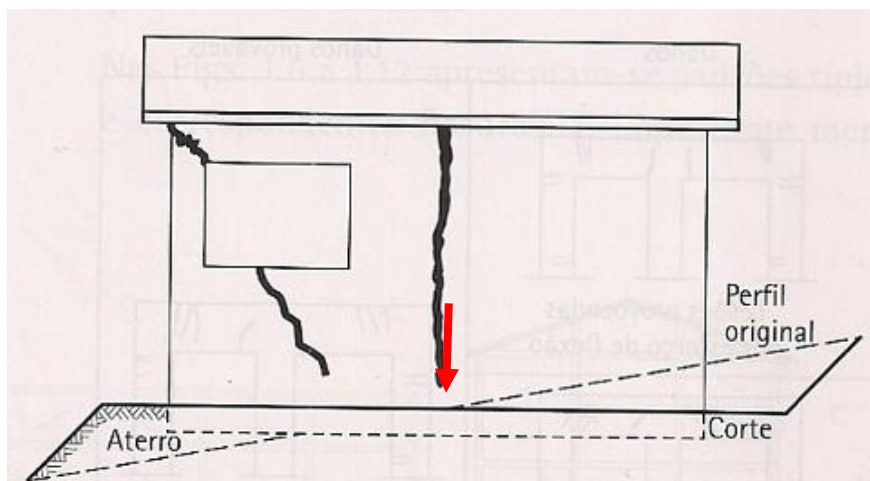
Provável fissuramento de edificação assente parte em aterro* (apud Ureil Ortiz, 1983) (MILITITSKY, Jarbas; CONSOLI, Nilo Cesar; SCHNAID, Fernando; Patologia das Fundações, pag. 26; São Paulo, 2008)
